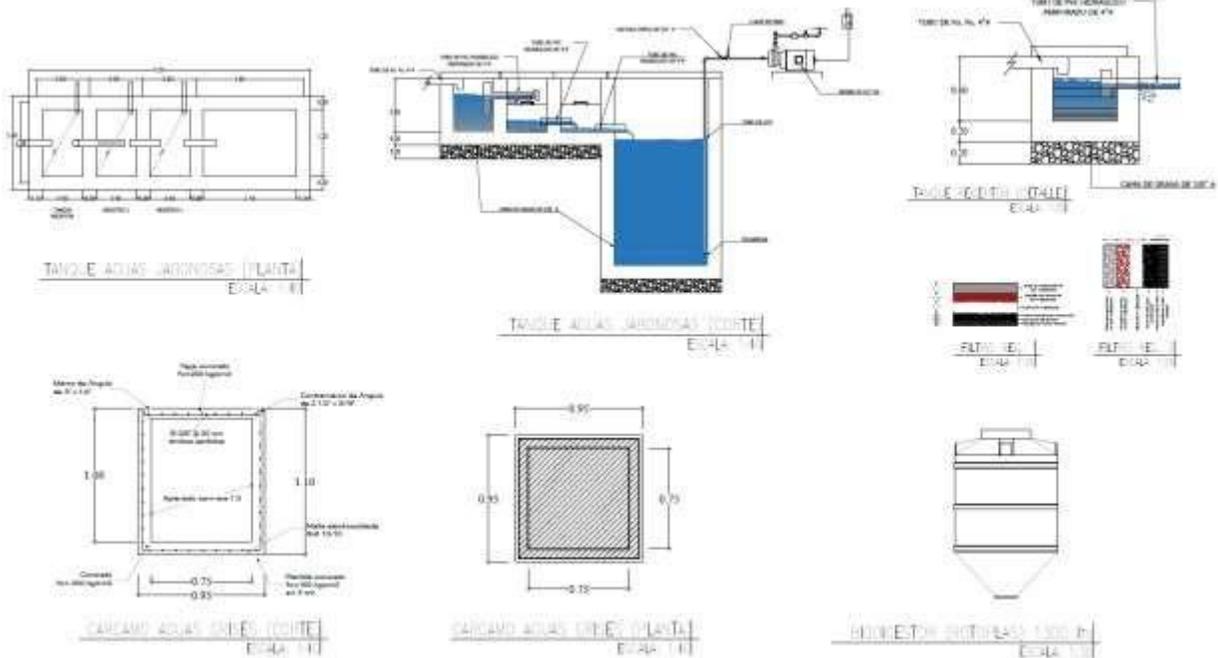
Detalles constructivos de la red de drenaje sanitario de la vivienda
